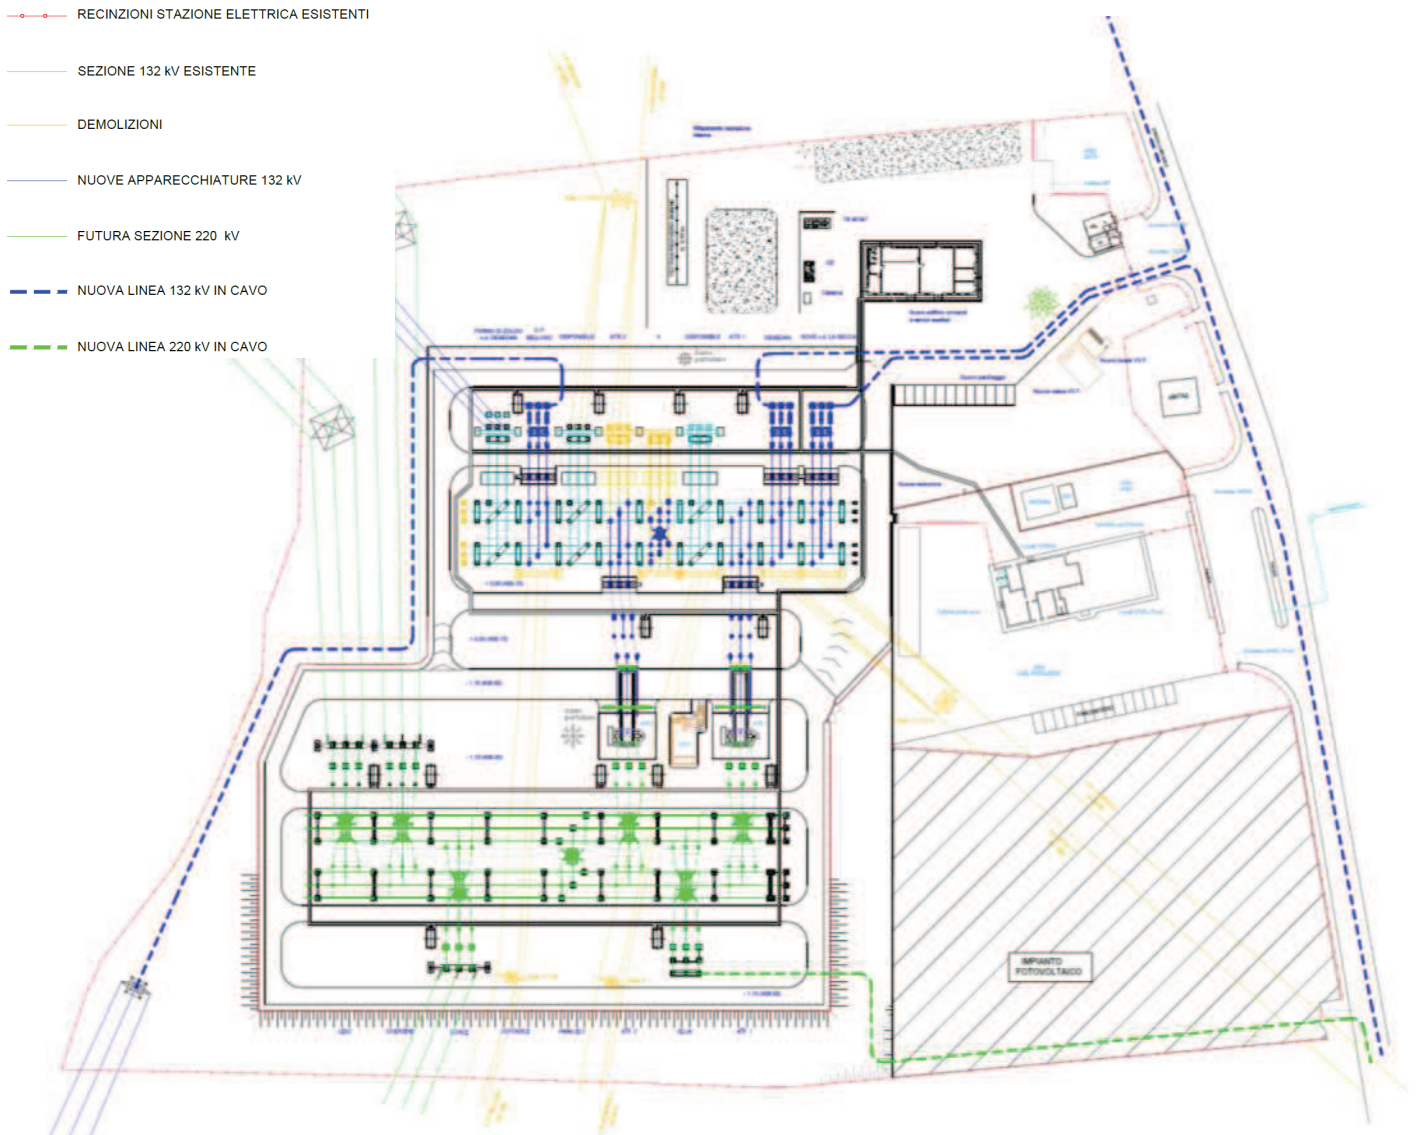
Planimetria elettromeccanica - Stato di Progetto
